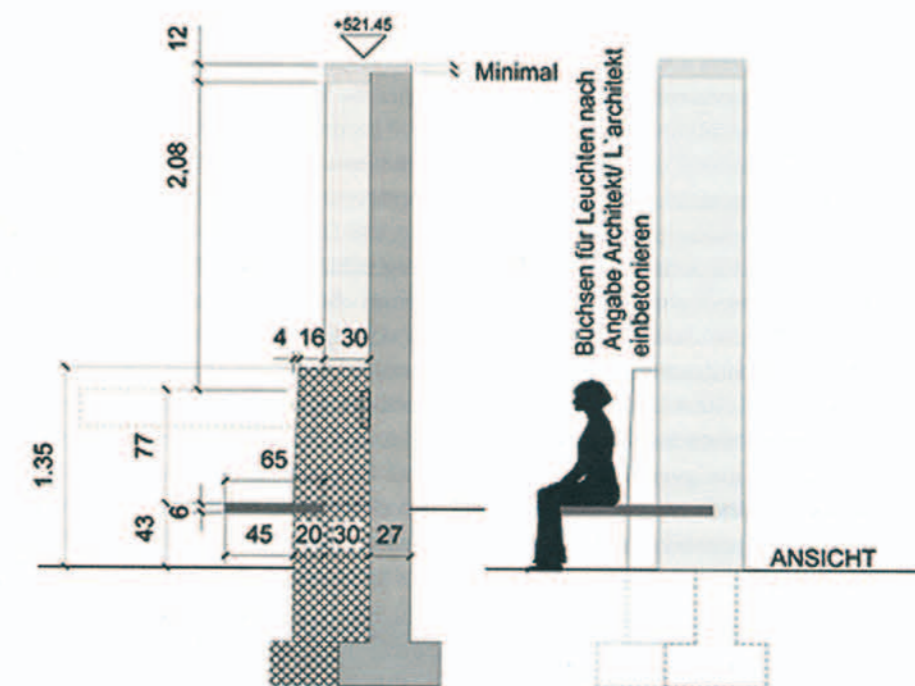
Detailplan der Betonmauer mit Sitzfläche
